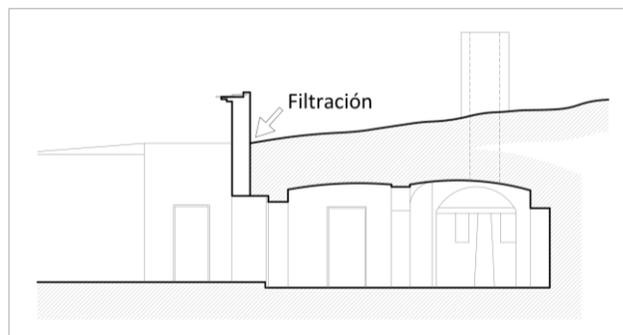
Grietas impermeabilizadas en revestimiento de cubierta. Cueva 18_04_11 de Monóvar
